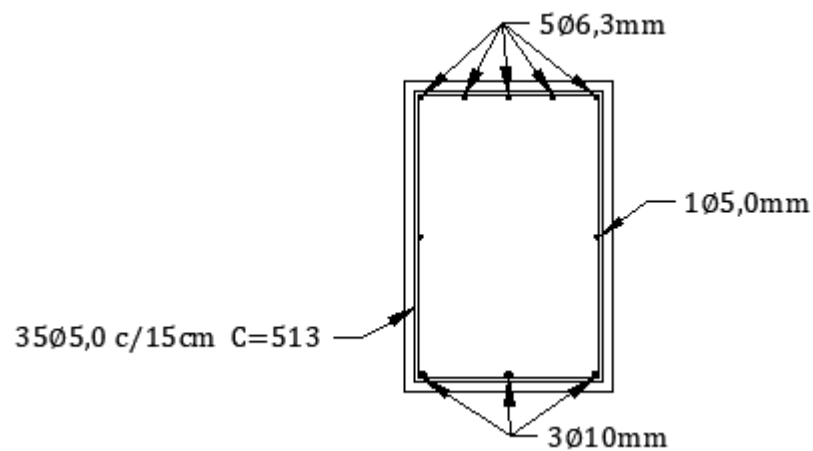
Detalhamento da viga lateral inclinada, obtido a partir do CYPECAD (Fonte: autor).
